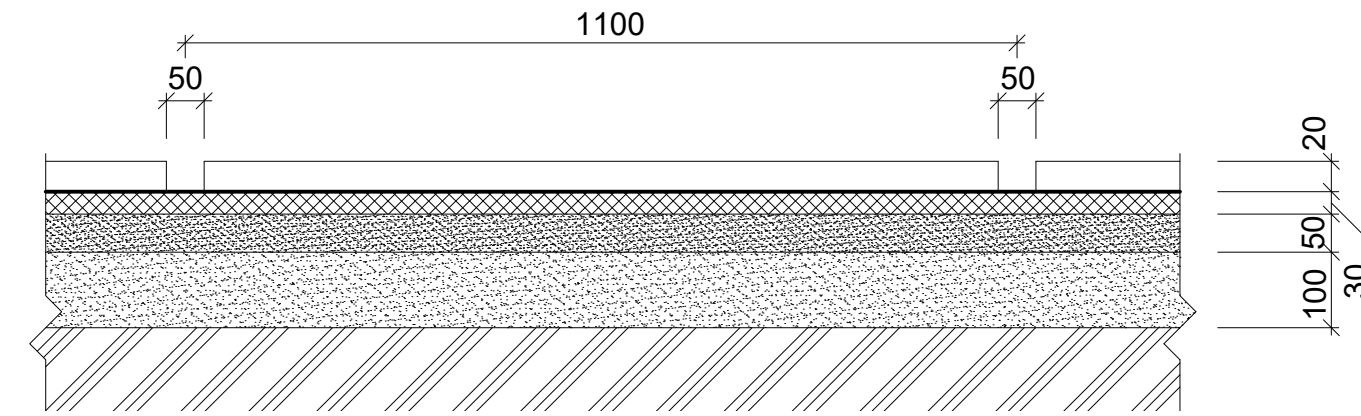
Detail zasakovacího tělesa, M 1:10, zdroj: autor práce
